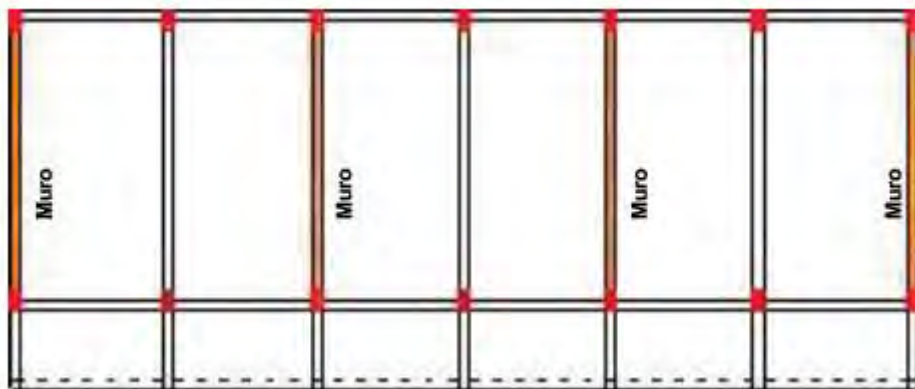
Planta del tipo 780 PRE (Fuente: Muñoz et al, 2007)
